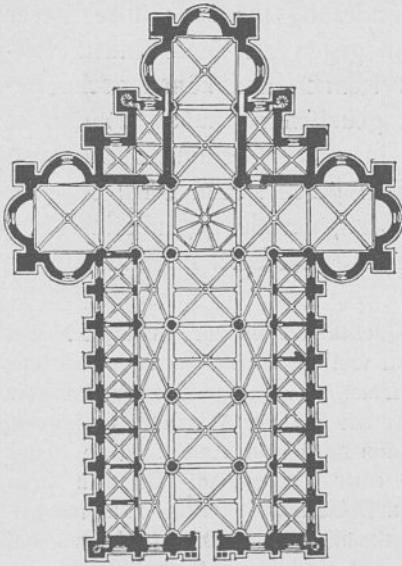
Pavia, Certosa, Grundriß der Kirche.
